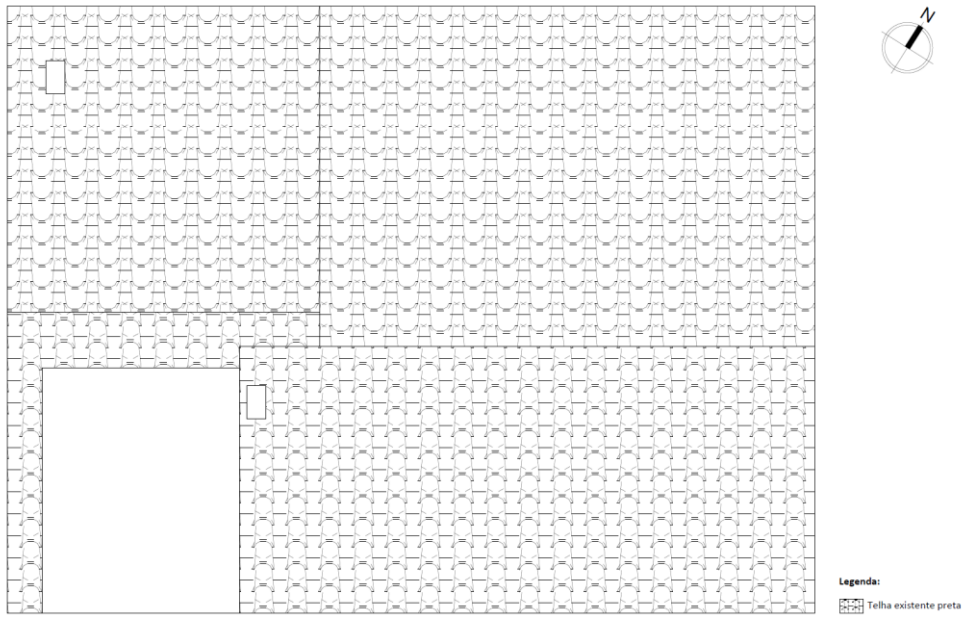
Planta de cobertura. Fonte: Marisa Francisco.
